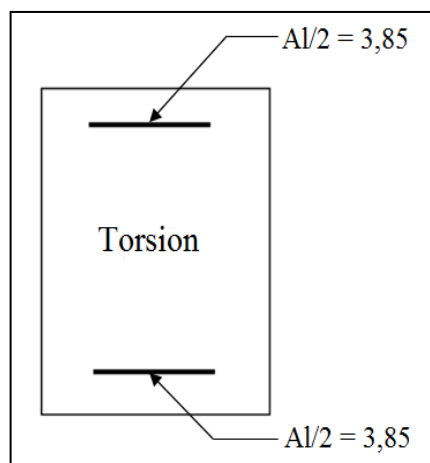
Section d'armatures de la poutre palière calculée à la torsion
